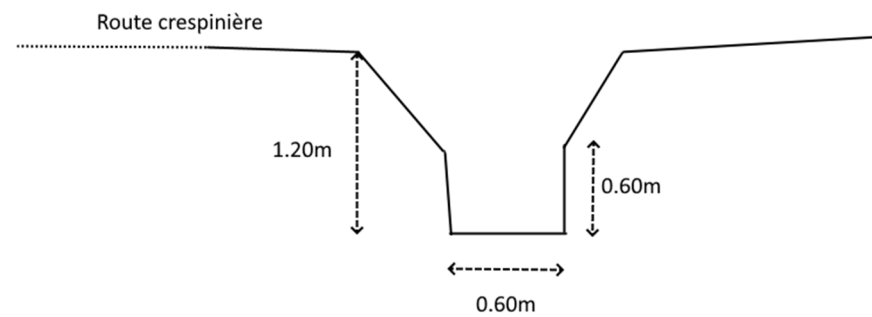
coupe moyenne du ruisseau en section amont – coupe A
